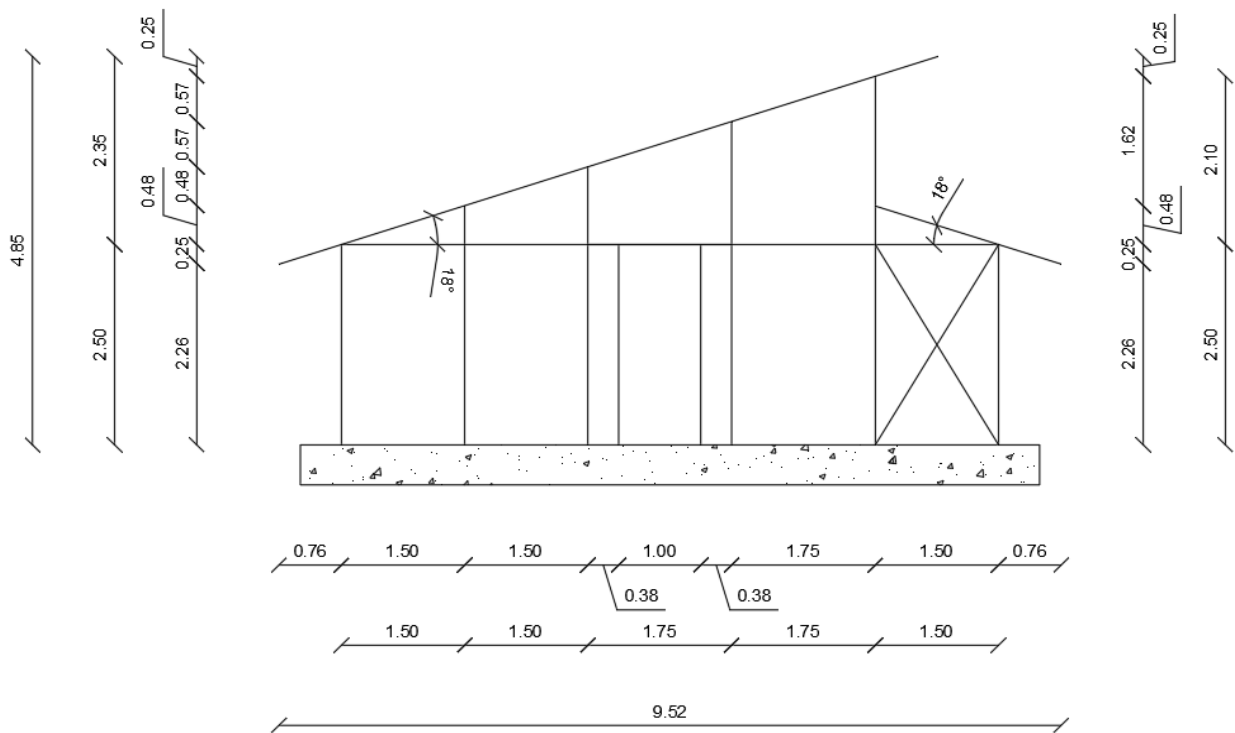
Prospetto Sud dell'edificio a seguito delle modifiche.
